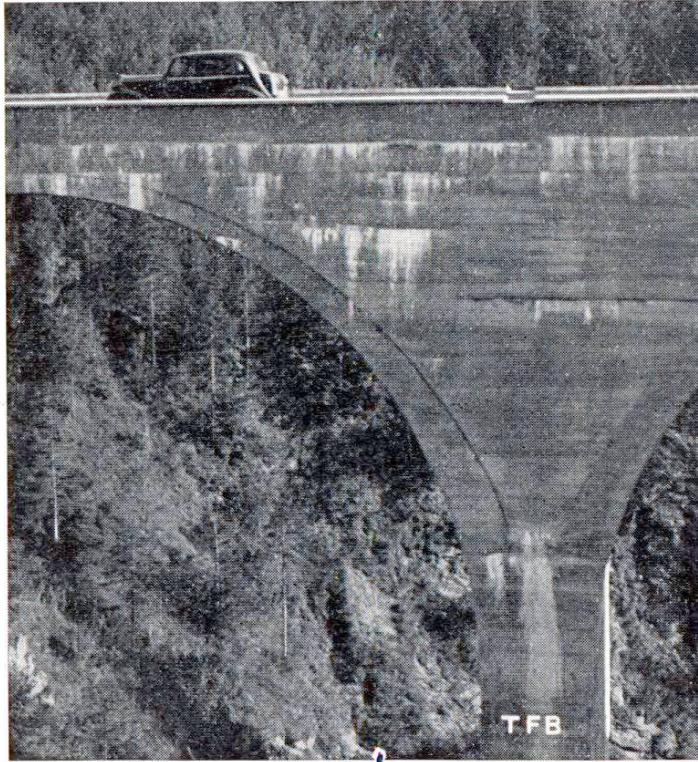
Efflorescences calcaires sur les murs frontaux d'un pont en béton armé (trainées blanches partant des joints de reprise).
